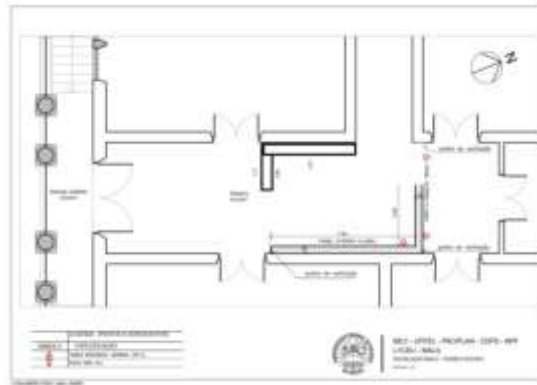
Planta Baixa Galeria Luciana Renk Reis
